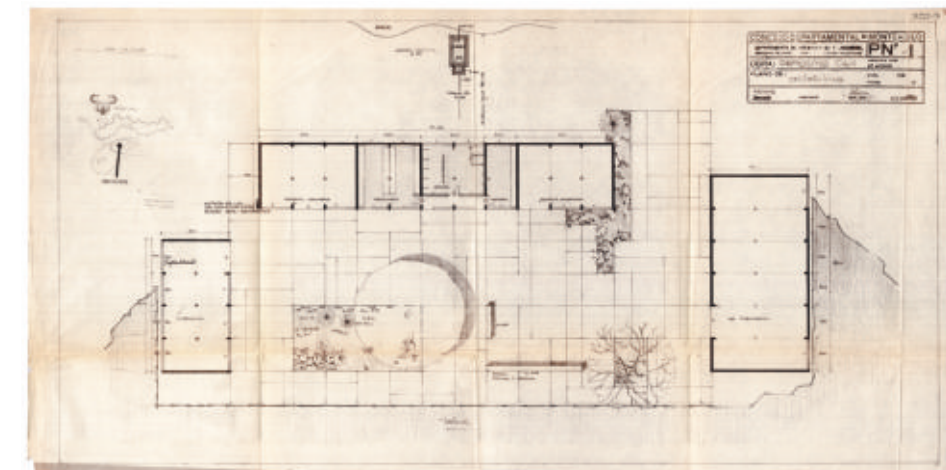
Planta de los depósitos para el Cementerio del Norte. FUENTE: IHA, Fondo Bayardo, Carpeta 3222/13.
